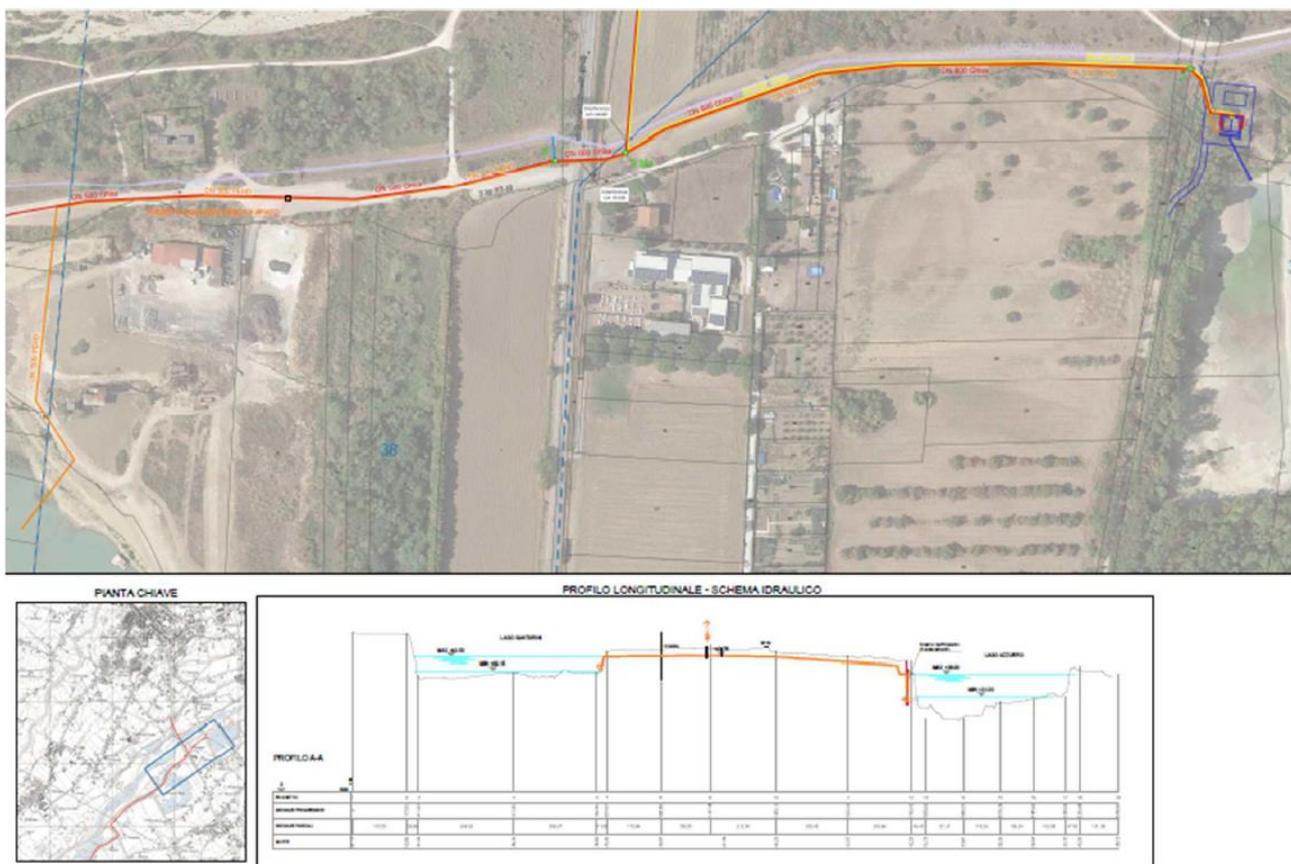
Planimetria e profilo della condotta di collegamento tra i laghi
